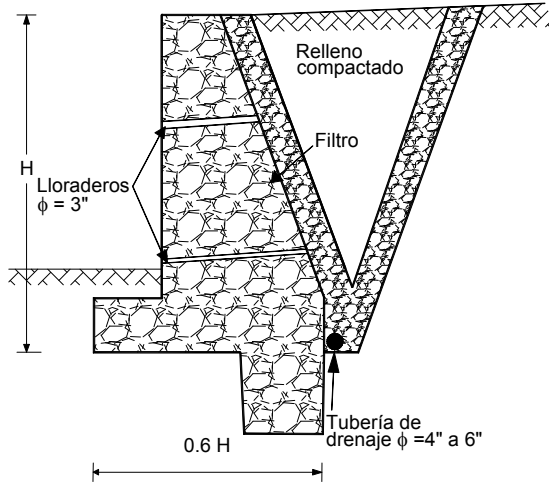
Esquema de un muro en concreto ciclópeo.
